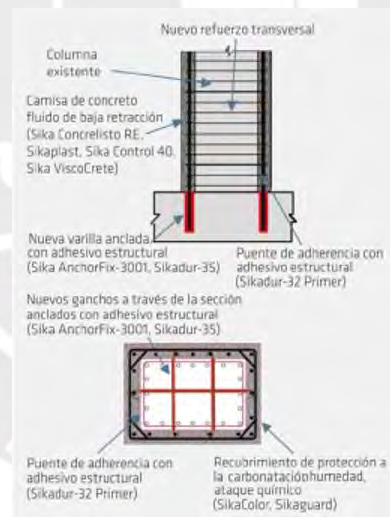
Encamisado de concreto en una columna. (Fuente: Reforzamiento de estructuras de concreto - Sika)
